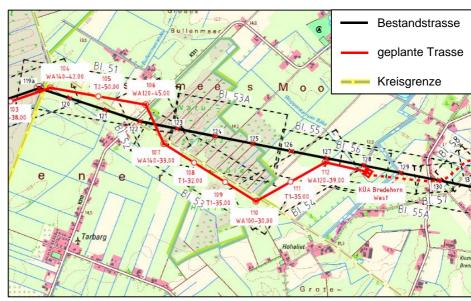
Ausschnitt aus dem Übersichtsplan zum Planfeststellungsverfahren (Anlage 4.3)
